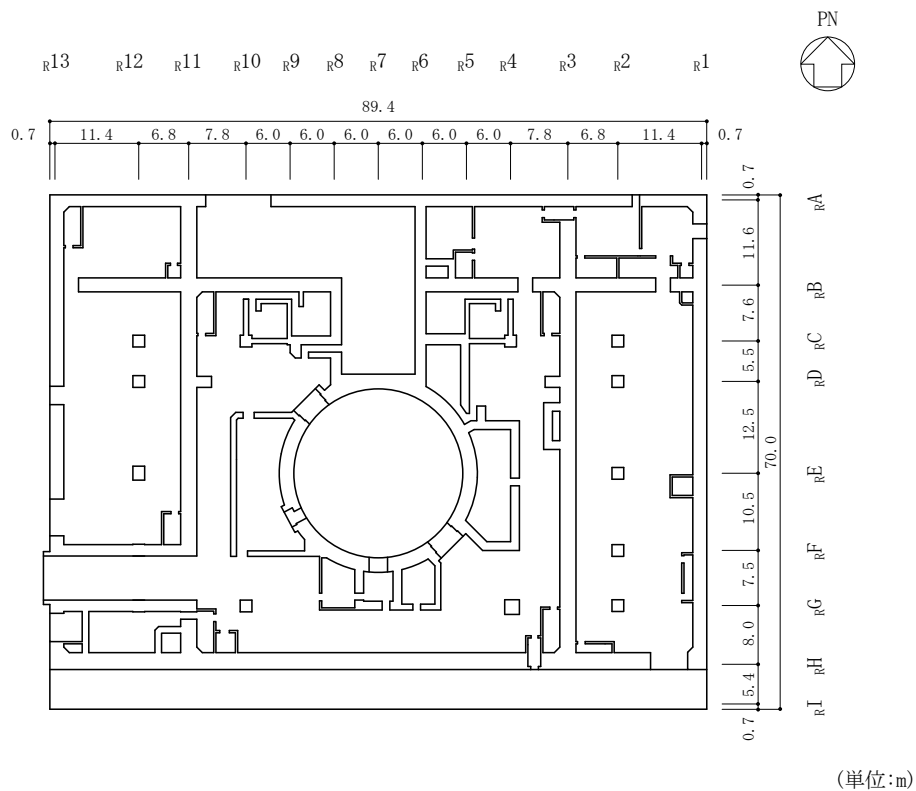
(3) 原子炉建物の概略平面図 (EL 15.3m)
